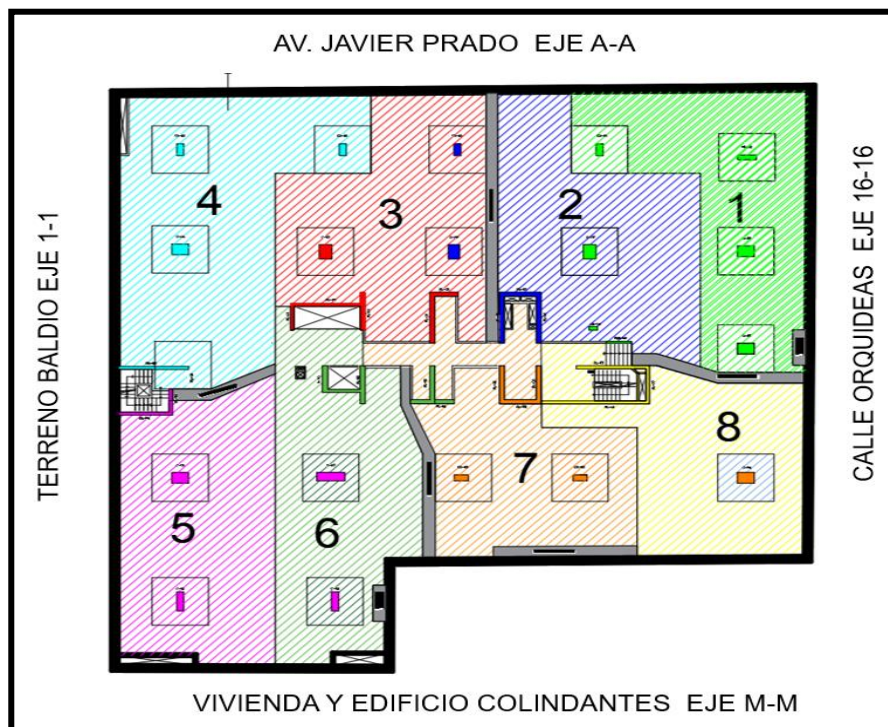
Vista en Planta de la Sectorización Sótanos
